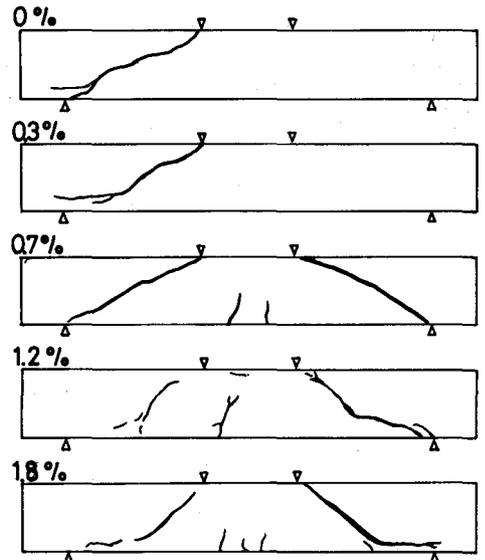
繊維補強鉄筋コンクリートはりの破壊状況
